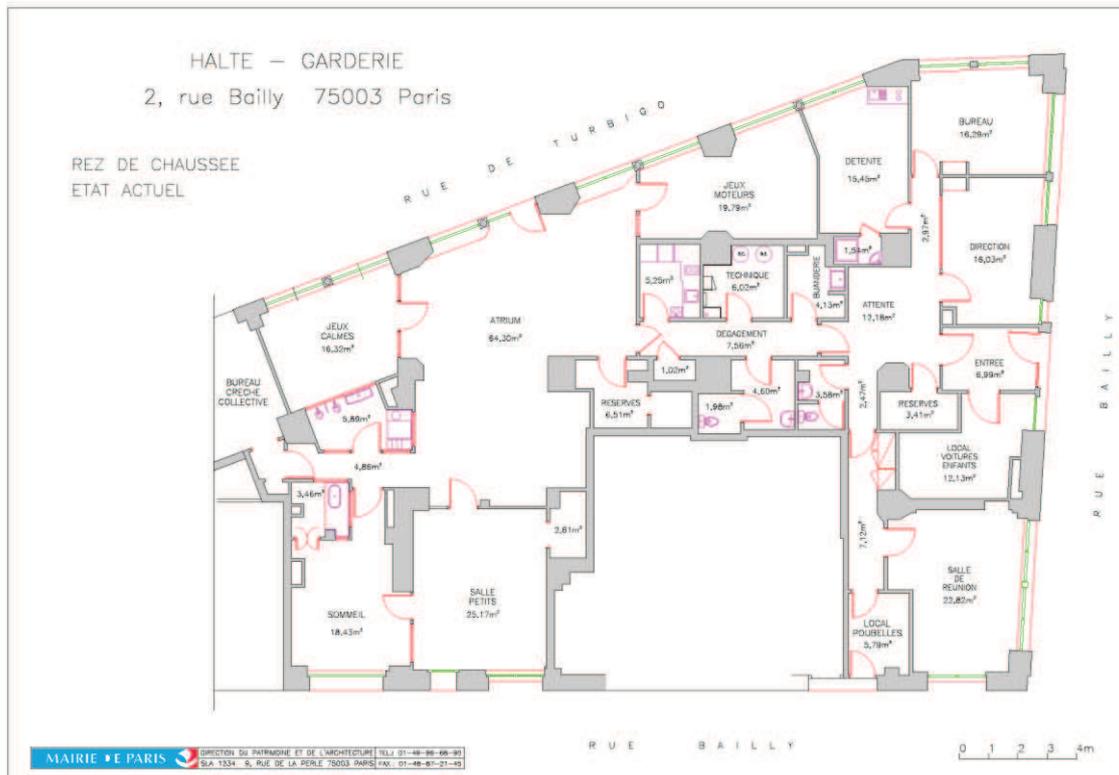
Plan de l'état existant de la halte-garderie Bailly
